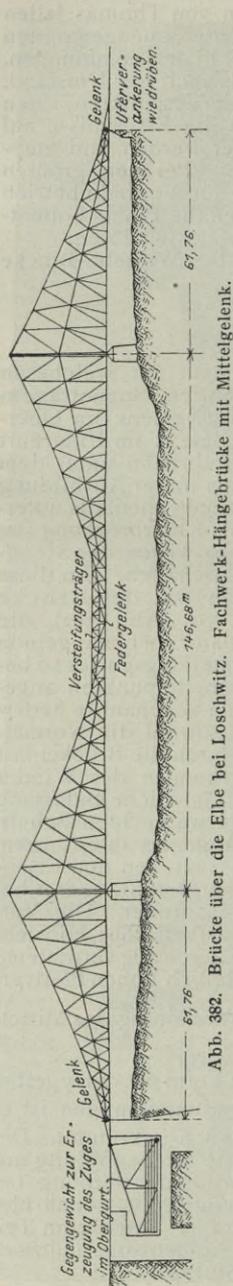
Brücke über die Elbe bei Loschwitz. Fachwerk-Hängebrücke mit Mittelgelenk.
